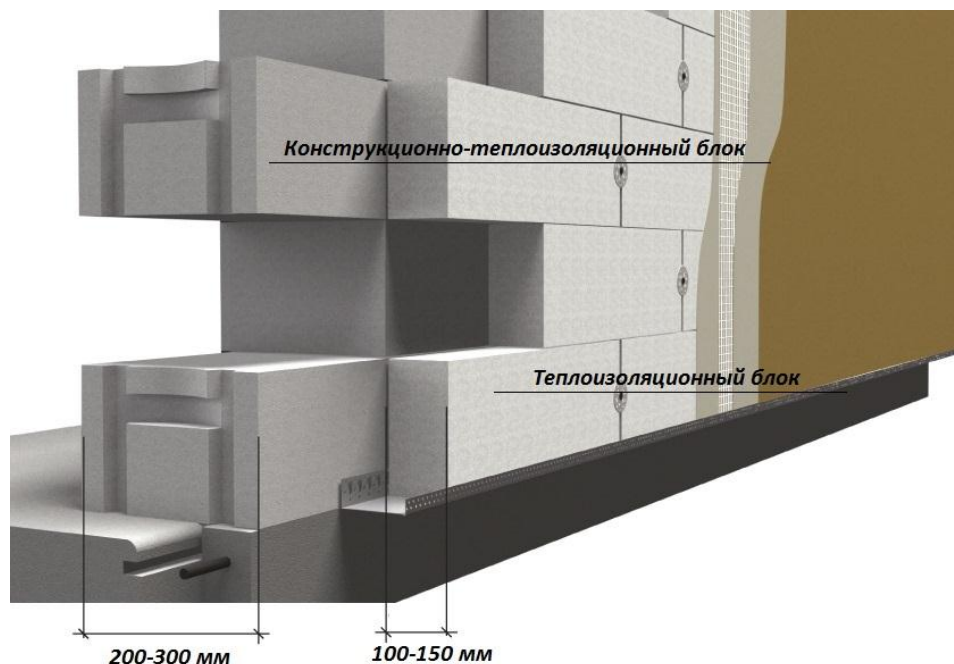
Двухслойная стена из газобетона D300-D500 в сочетании с теплоизоляционными плитами D150
